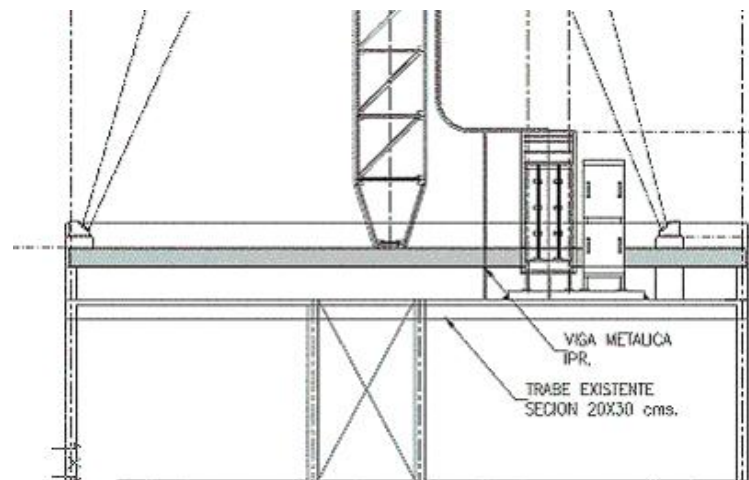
TORRE SOBRE VIGA METÁLICA
